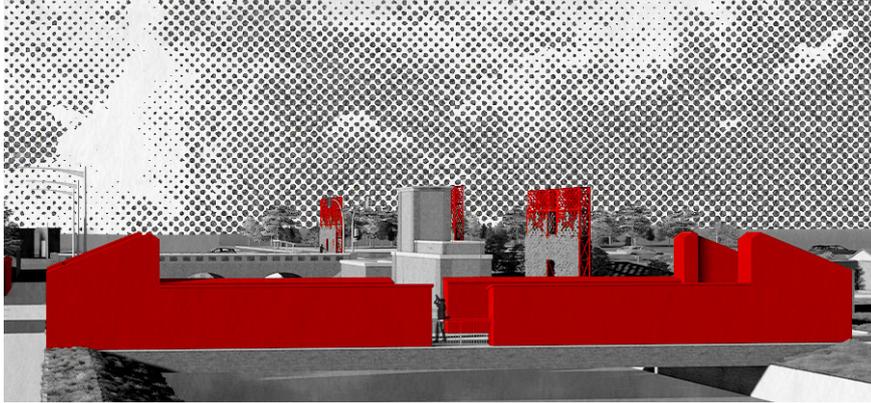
Vista renderizzata dell'attraversamento del Canale Cavour. Estratto della tavola 07_ Prospetti e sezioni.
